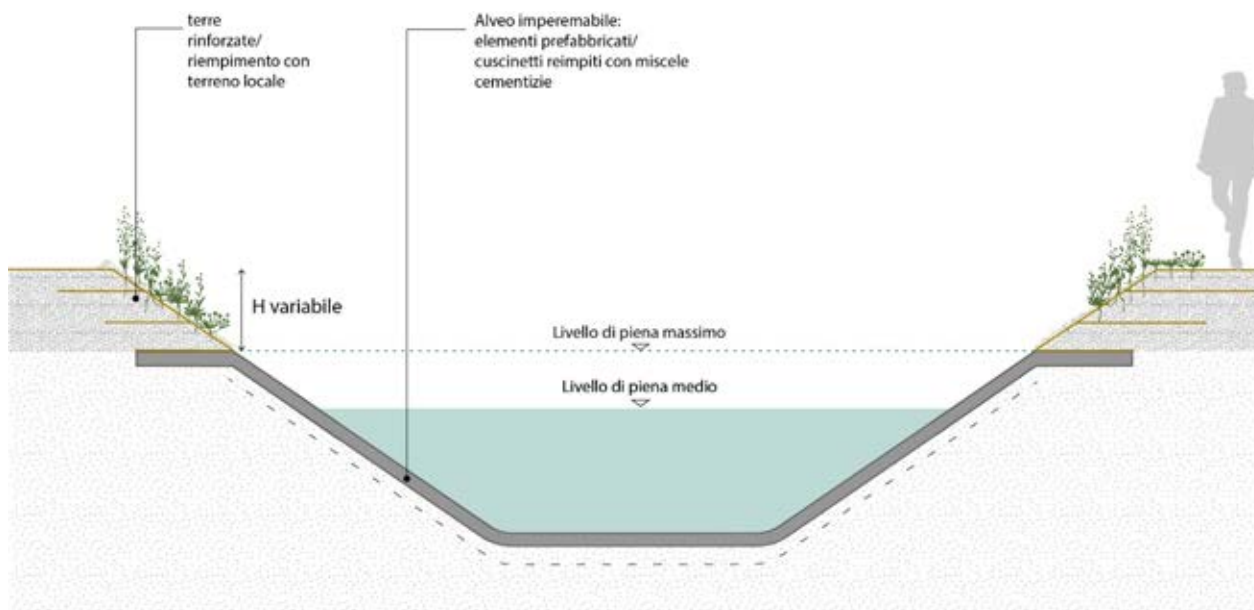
Sezione tipo – utilizzo di elementi prefabbricati in associazione a interventi di idrosemina o ingegneria naturalistica (rielaborazione da Sistemi di protezione spondale Borghi Azio spa)
